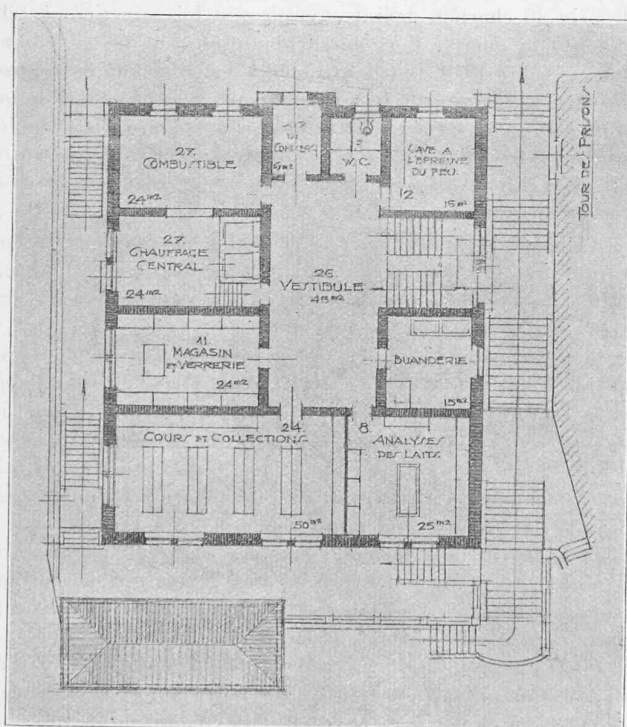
Plan du sous-sol supérieur. — 1 : 300.
